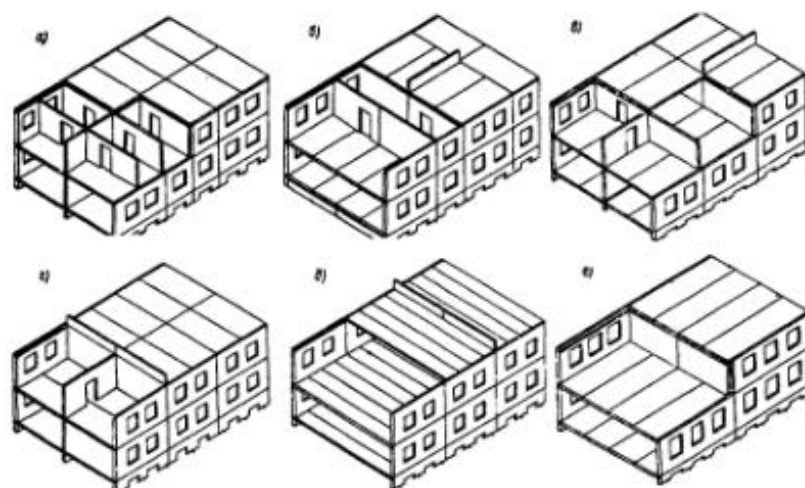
Варианты бескаркасной конструктивной системы: а - перекрестно - стеновой с малым шагом; б - поперечно - стеновой со смешанным шагом; в - поперечно - стеновой с большим шагом стен; г - продольно - стеновой (трехстенка); д - продольно - стеновой (двухстенка); е - поперечно - стеновой с увеличенным шагом стен
